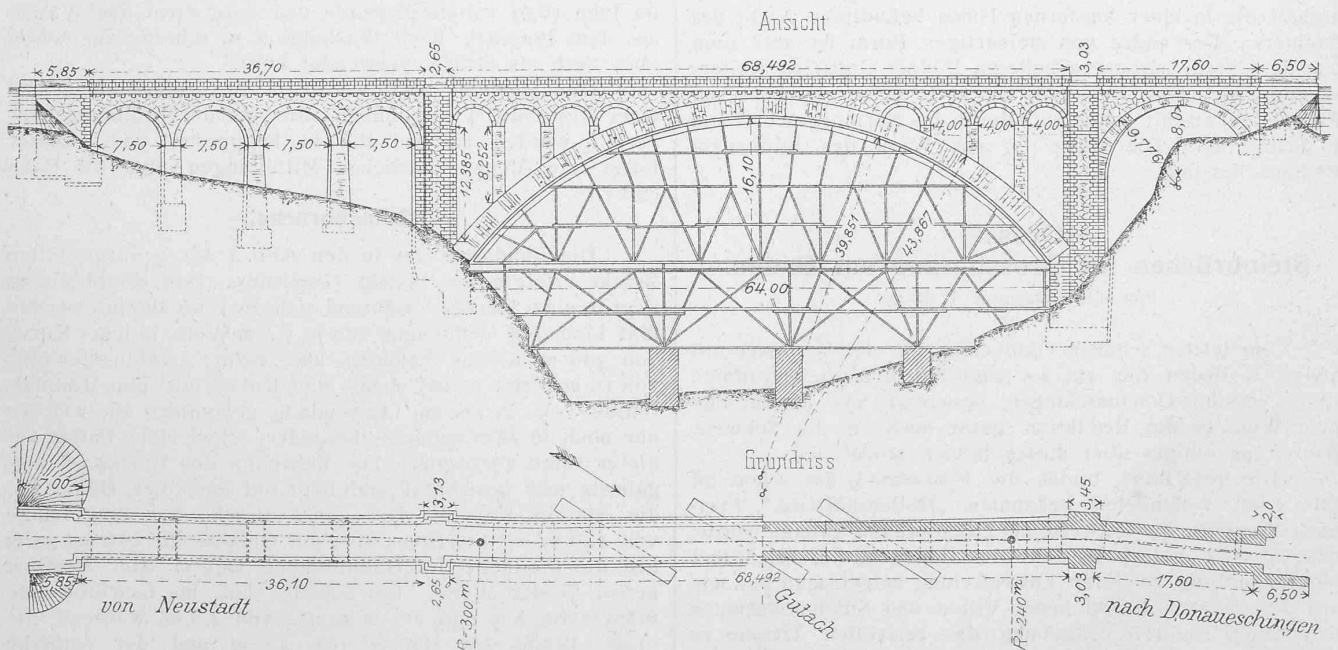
Ansicht und Grundriss. — Masstab 1:750.
